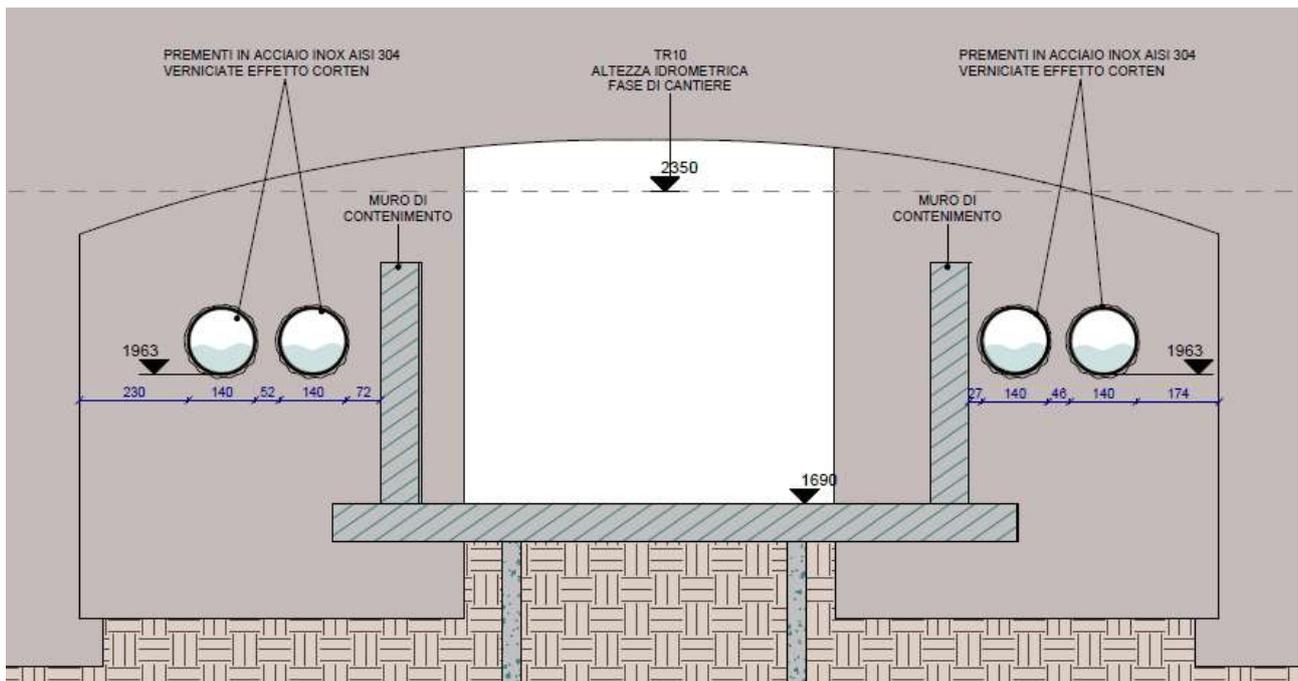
Sezione di dettaglio dell'attraversamento delle tubazioni sul ponte nave
